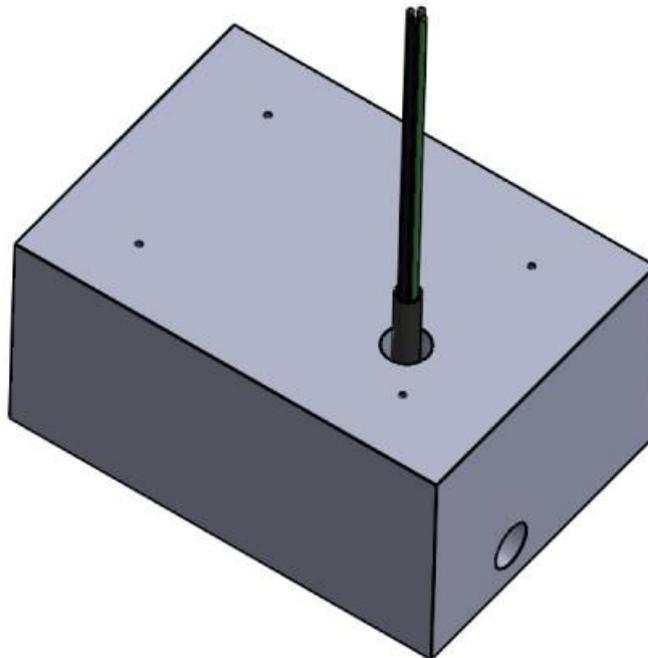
Isometrische Darstellung des Betonsockels CPC 50| 60|90|120 (rechts)
